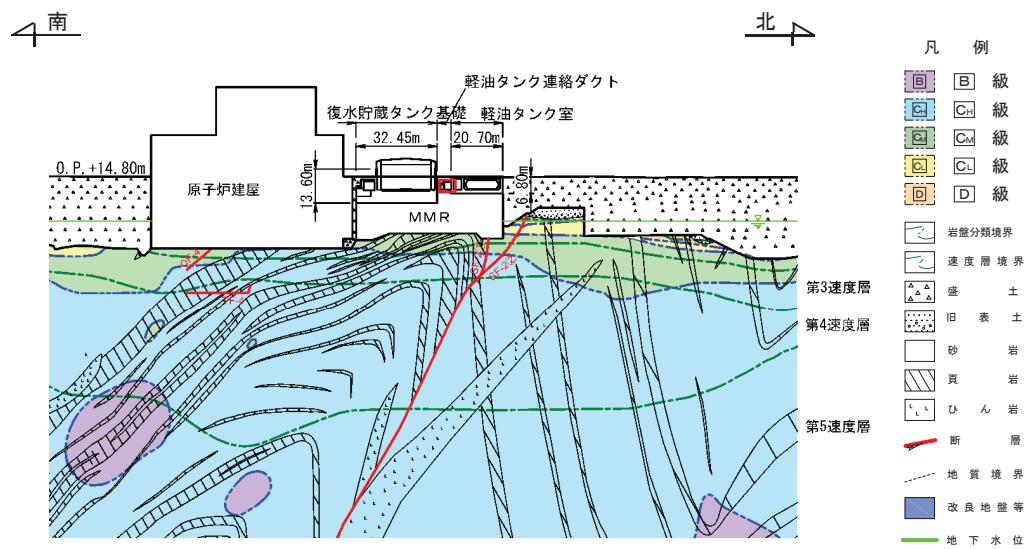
軽油タンク連絡ダクト地質断面図 (A-A)
